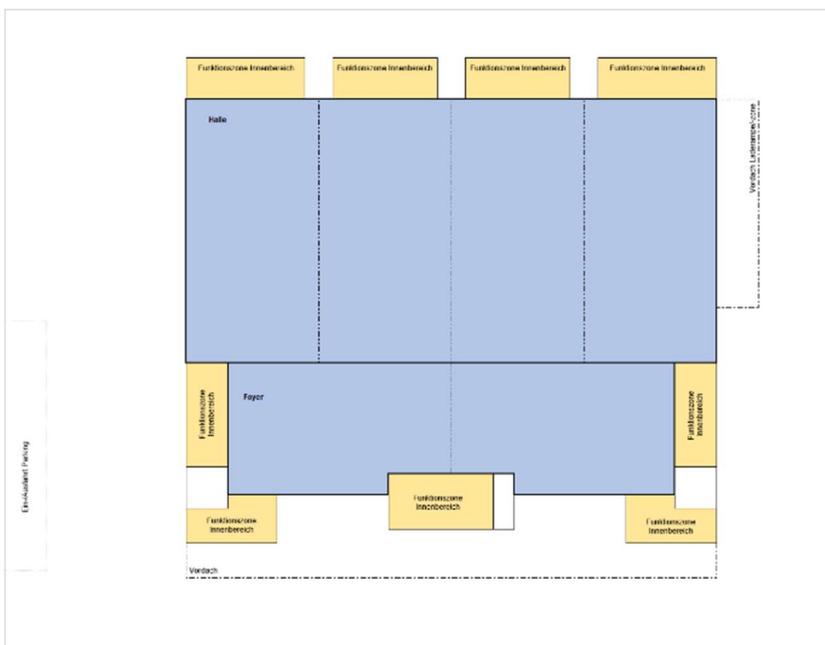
Schematischer Grundriss Erdgeschoss
